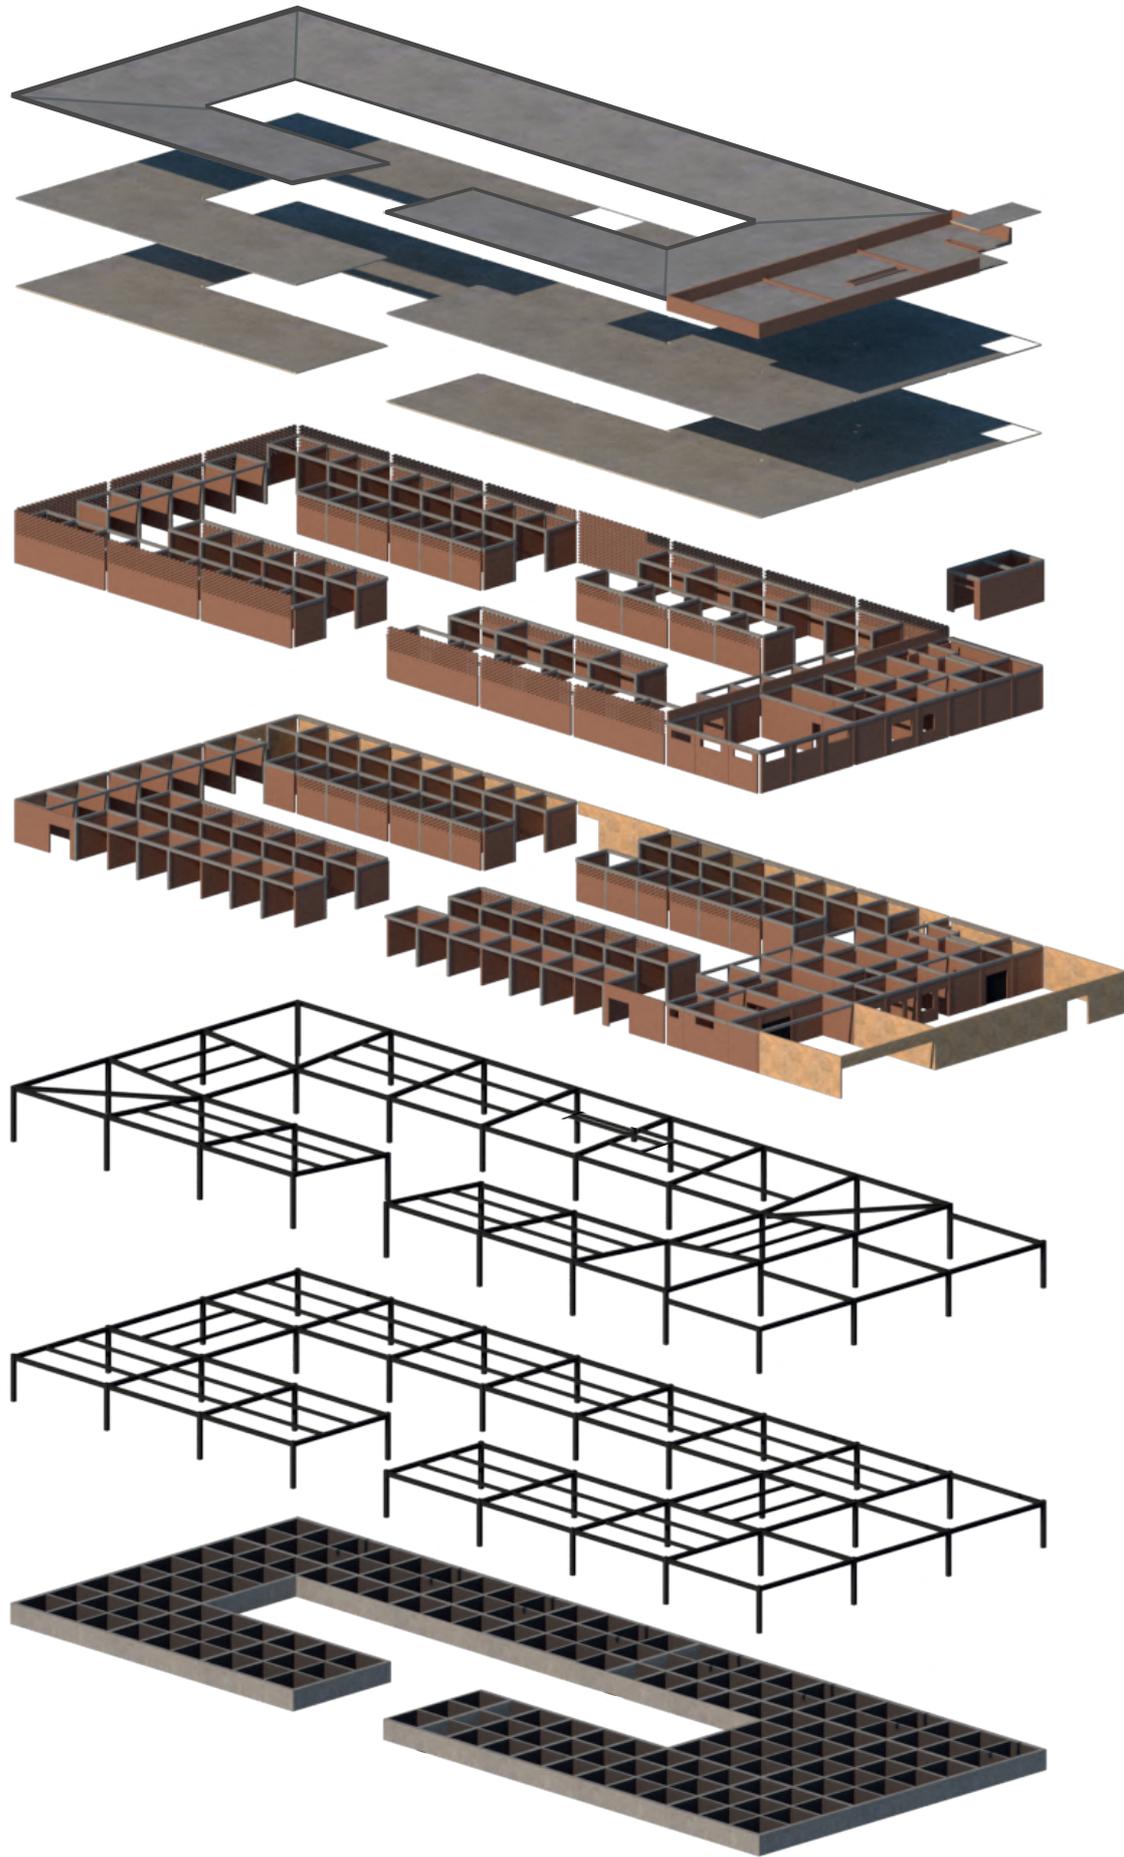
Isométrico explotado del sistema estructural de propuesta de reconstrucción del Mercado Chamizal. Elaboración propia.
